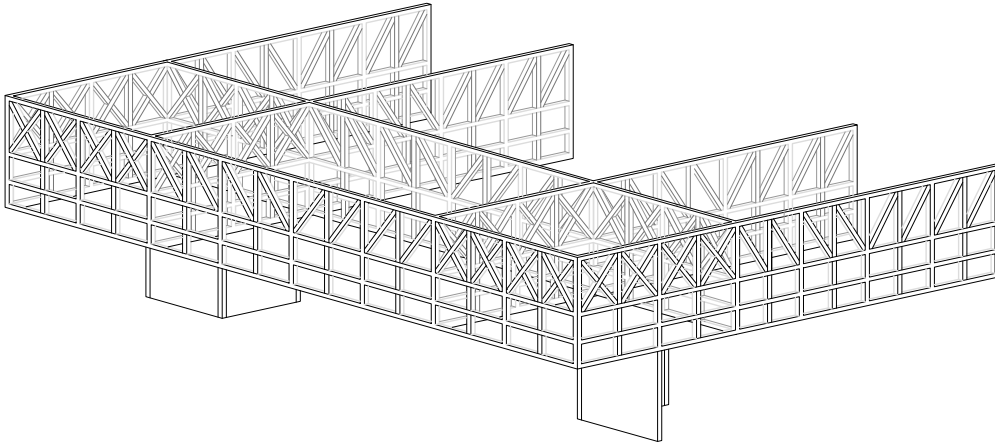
Esquema do sistema construtivo do primeiro piso.
